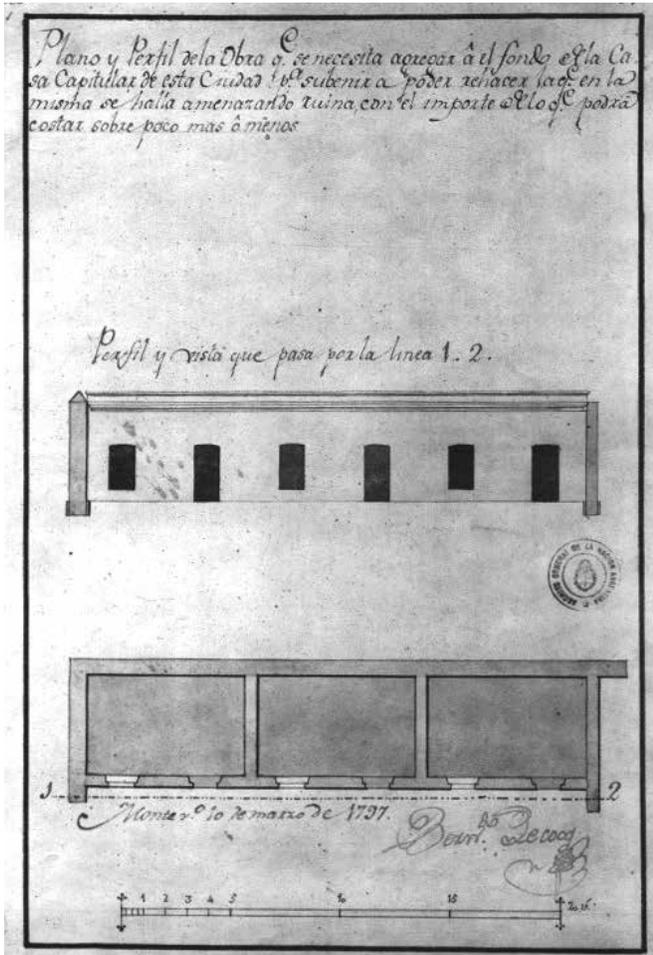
PLANO Y PERFIL DE CONSTRUCCIÓN INCORPORADA AL FONDO DE LA CASA CAPITULAR, FIRMADO POR B. LECOCQ.
